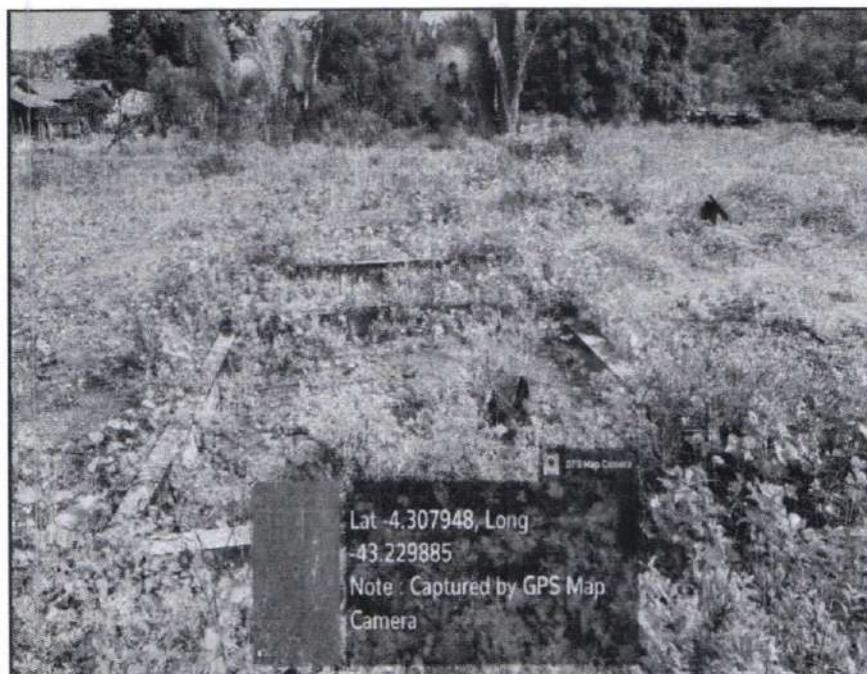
Vigas baldrame encontram-se expostas, sem o aterro previsto executado e sem o recebimento de impermeabilização. Fonte: elaboração própria
